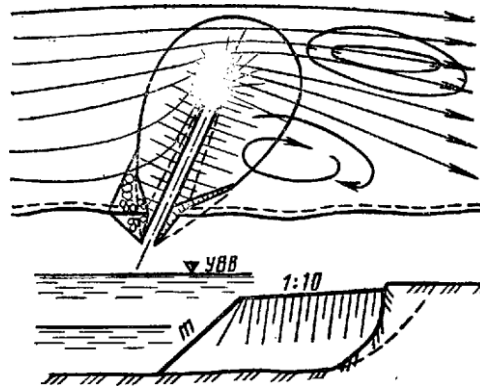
Глухая шпора из грунта с облицованным рабочим откосом
